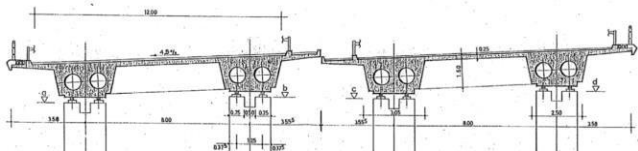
Desenho de projeto da estrutura do tabuleiro em laje nervurada (corte transversal)
